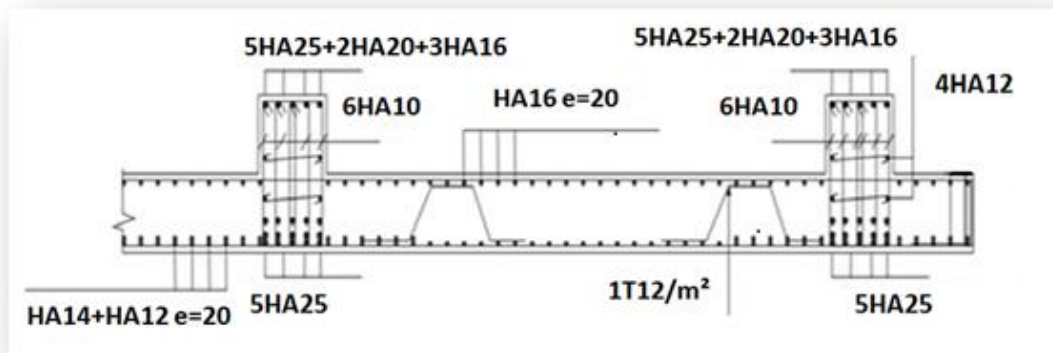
Schéma de ferrailage du radier en travée
